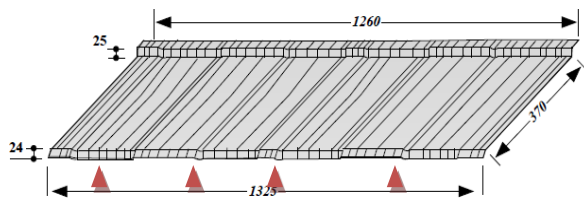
tuile METROTILE® WOODSHAKE - position des fixations
